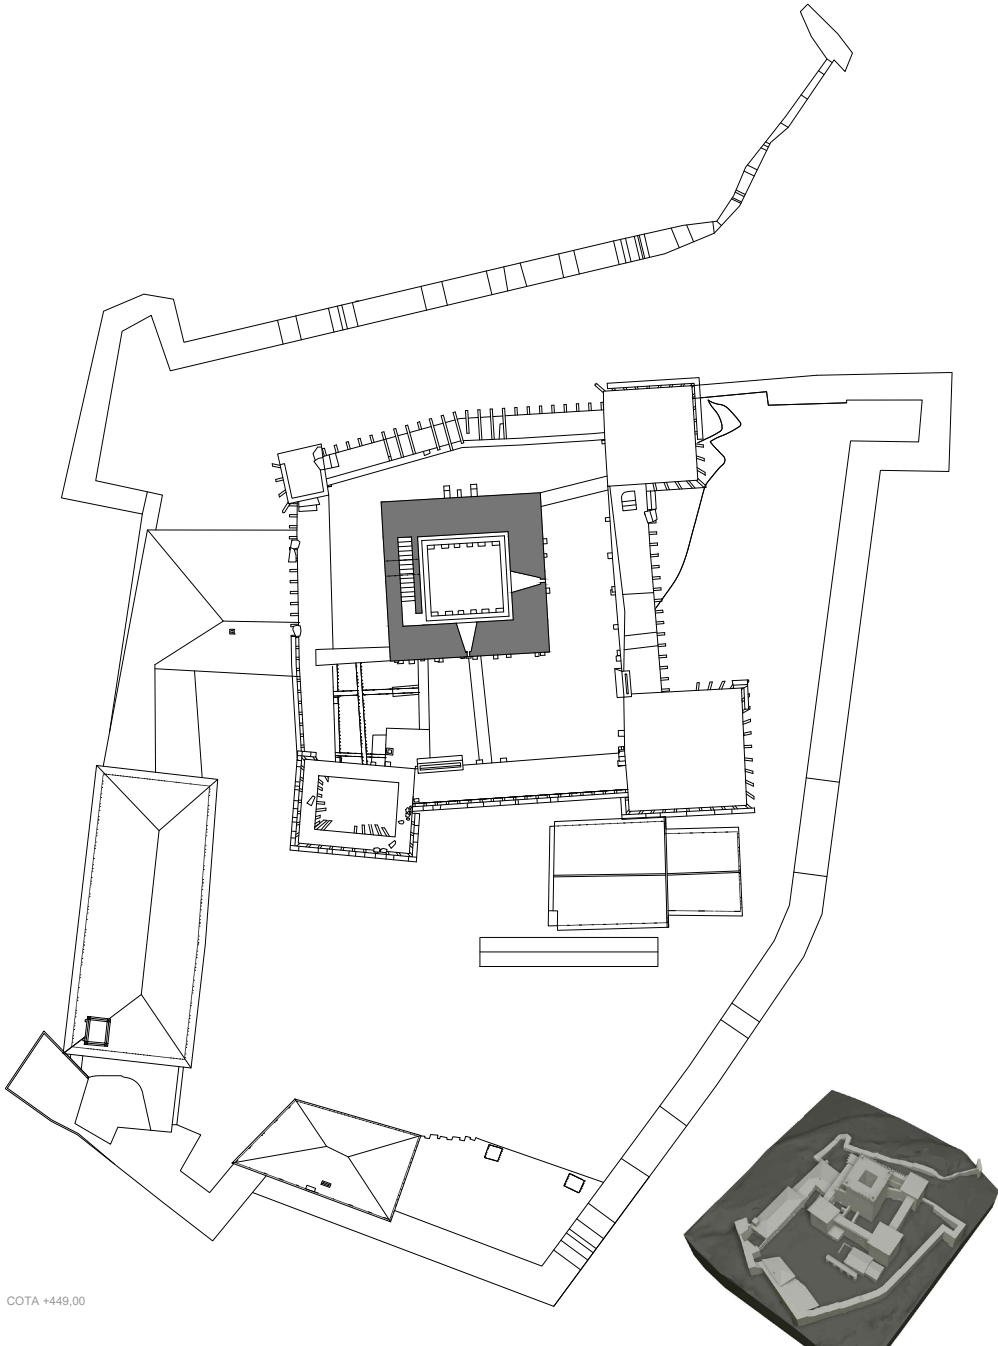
Planta de cubiertas. ESTADO ACTUAL.
